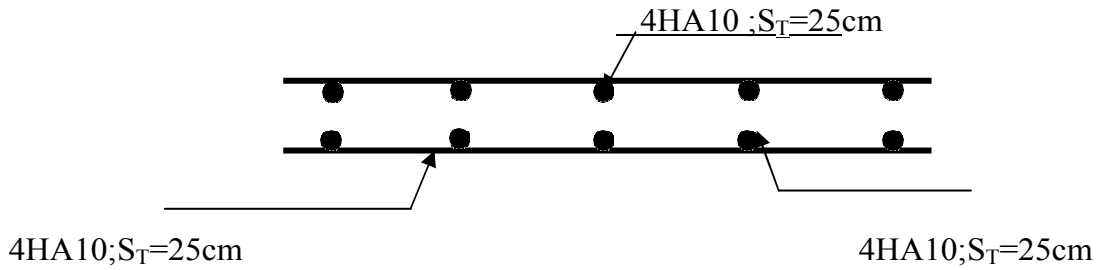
Schéma de ferrailage de la dalle sur 4 appuis
